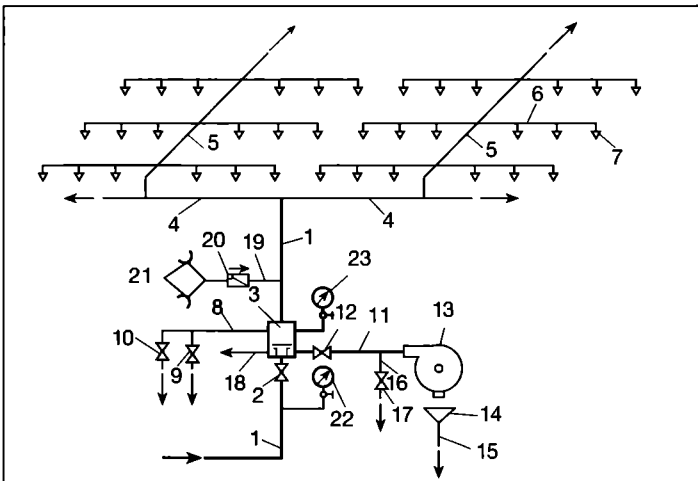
a. Schema de funcționare automată a instalației cu sprinklere în sistem apă - apă:
